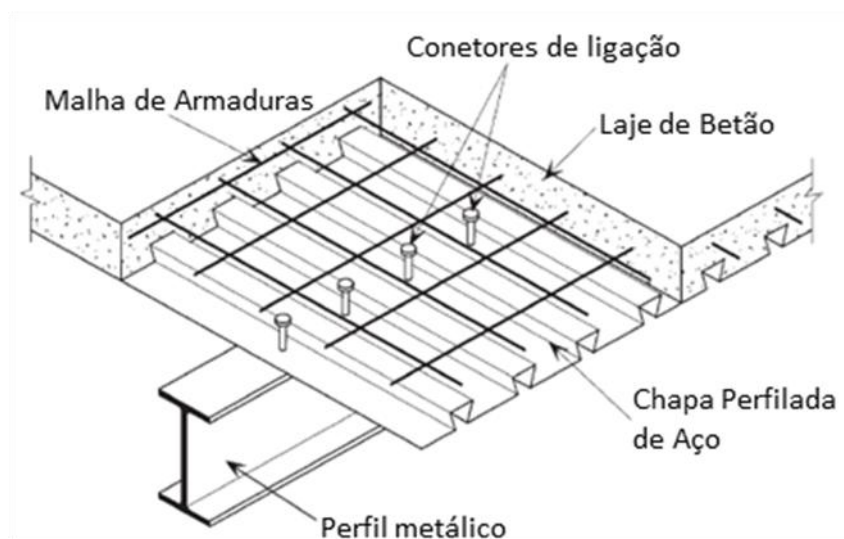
Estrutura de uma laje mista perfilada (C.G. Bailey, 2003).
